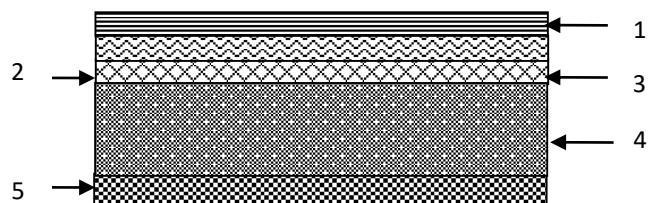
Coupe transversale dans le plancher à dalle pleine.
